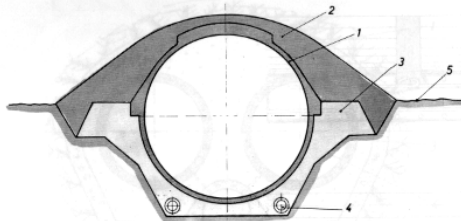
sección de tubería forzada de HºAº: 1- tubería forzada de HºAº, 2- recubrimiento de piedra apisonada, 3- soporte de hormigón en masa, 4- tuberías de drenaje, 5- terreno de grava.
